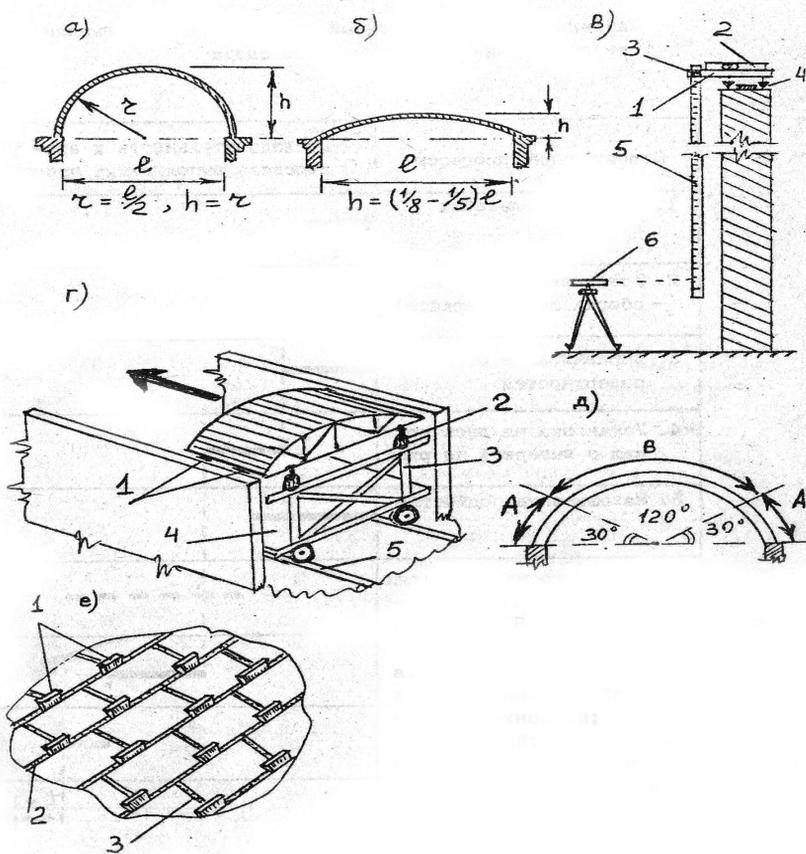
Возведение цилиндрических сводов: а) и б) – формы цилиндрических сводов; в) – выравнивание «горизонта» опорных поверхностей; г) – оборудование для возведение цилиндрических сводов: 1 – опалубка-кружало; 2 – домкраты; 3 – каркас для кружала; 4 – колёсная платформа; 5 – рельсовый путь; д) – деление цилиндрического свода на секторы; е) – технология «сухого» способа укладки кирпича в цилиндрический свод в секторе – В: 1 – деревянные клинья; 2 – продольные растворные швы; 3 – поперечные швы
